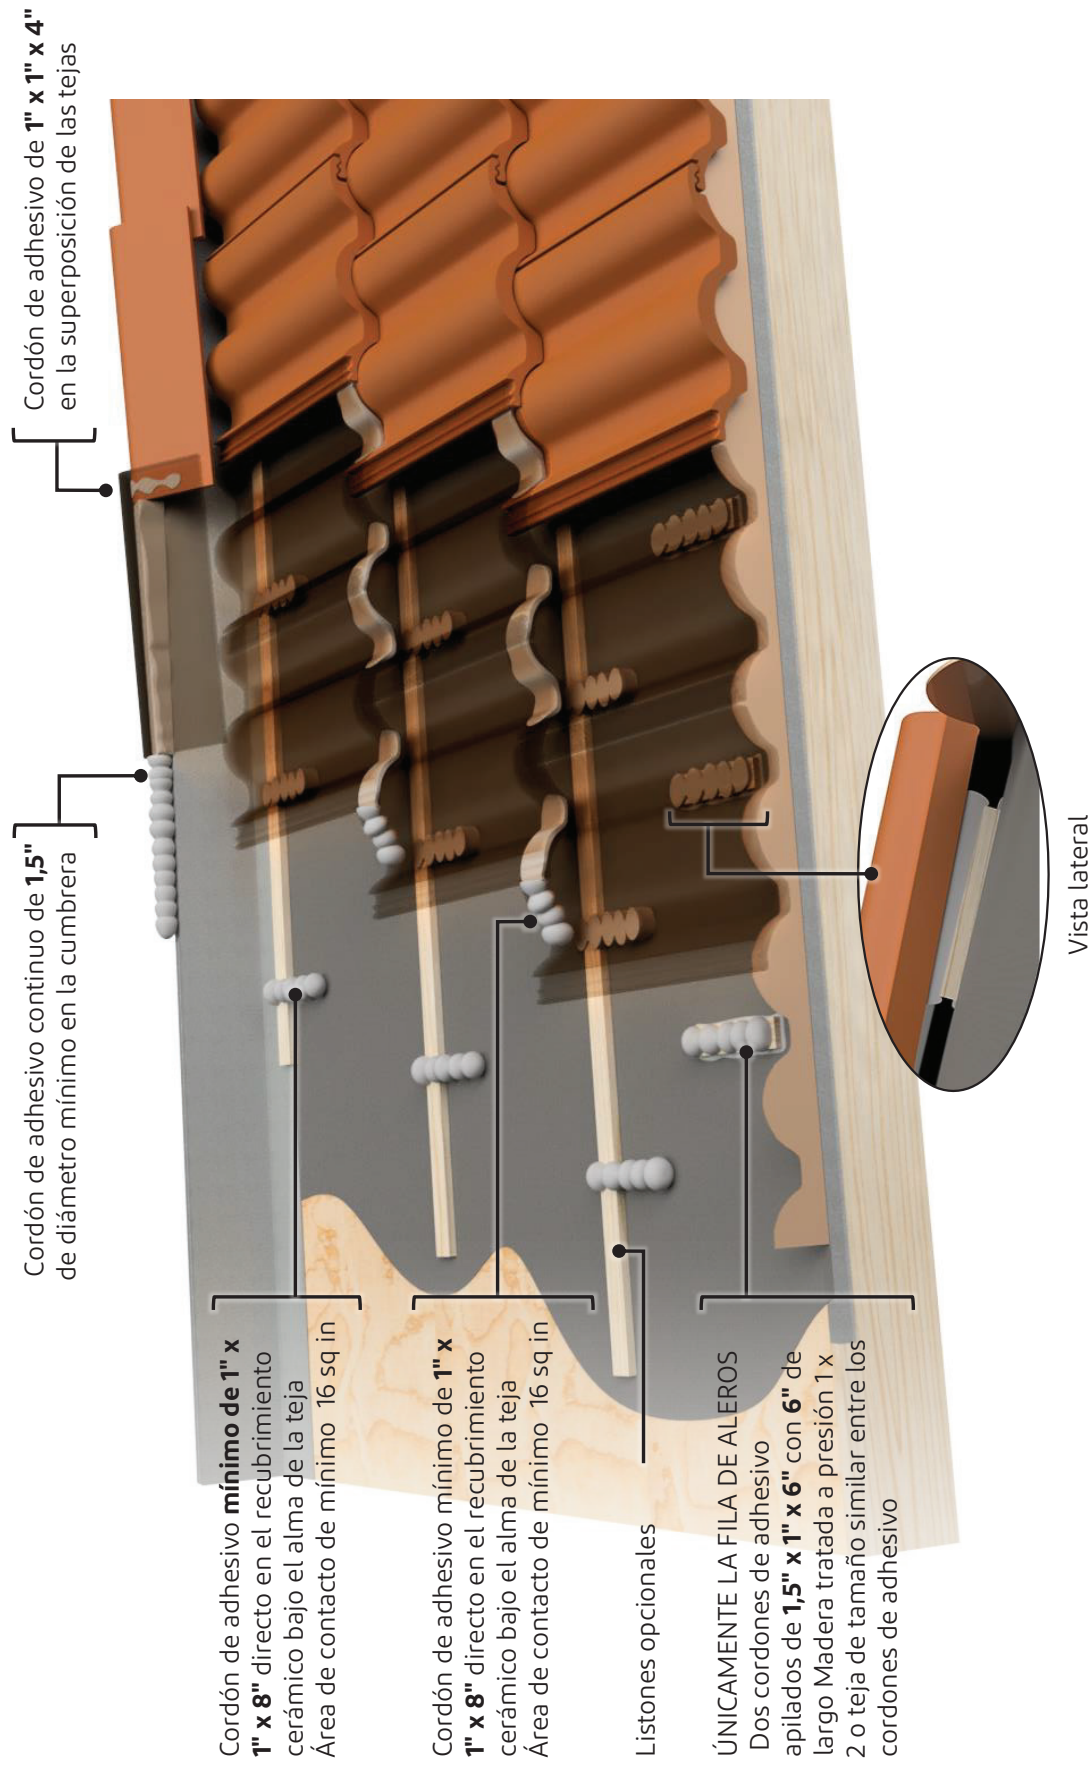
Colocación de adhesivo INDEPENDIENTE de perfil medio
